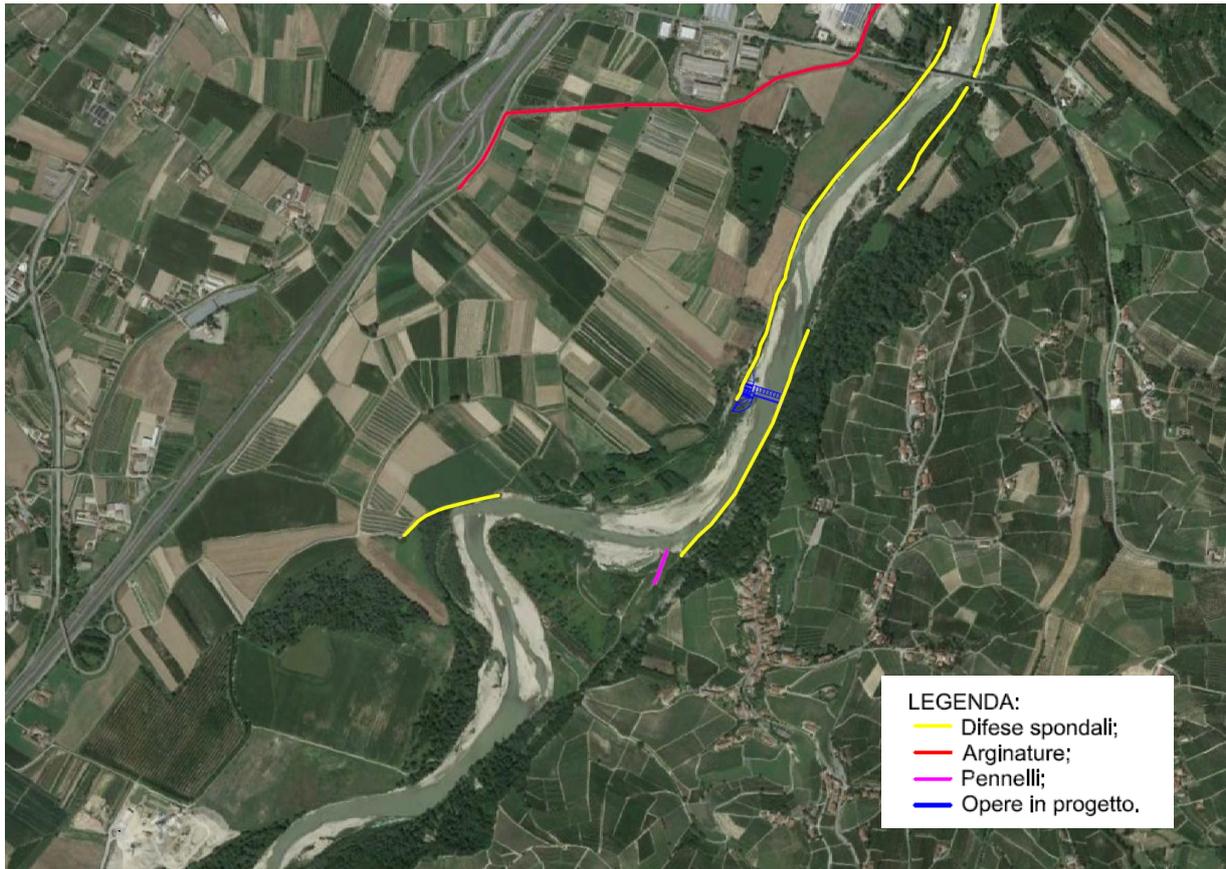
Planimetria opere idrauliche di difesa con sovrapposizione impianto in progetto
